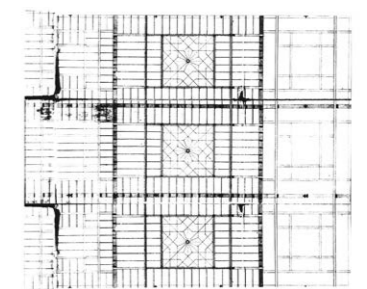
Deckenplan, eiserne Konstruktion, Einreichpläne 1855
